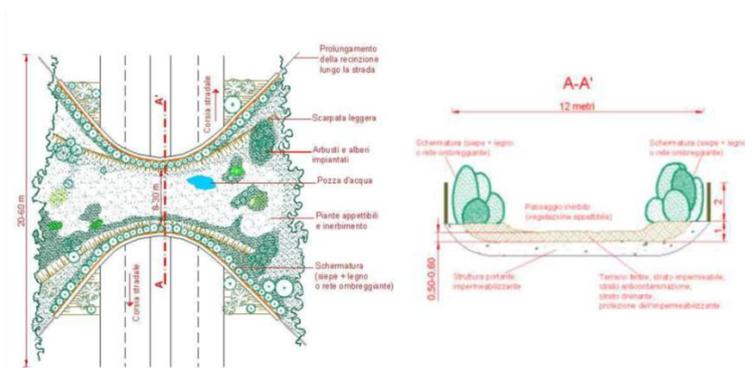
Planimetria e sezione di un Ecodotto ridisegnato e modificato da Dinetti, 2000
